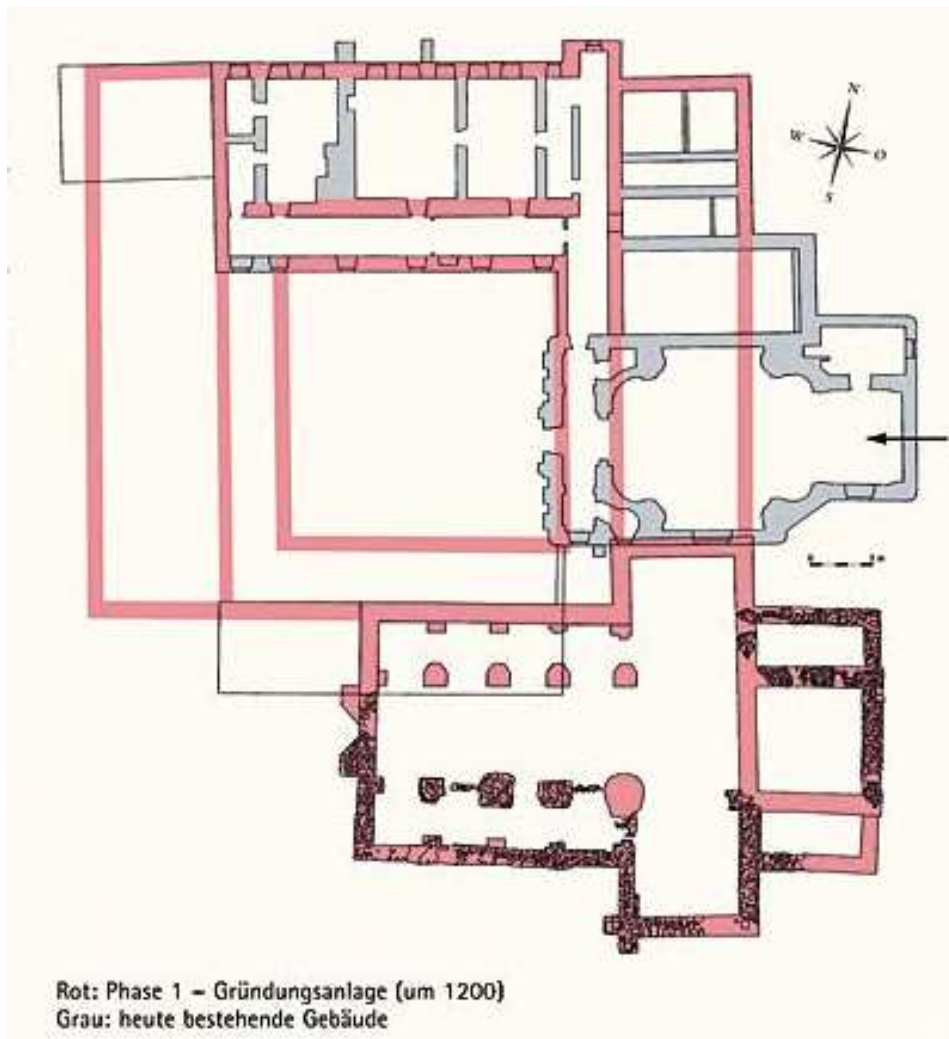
Klostermarienberg, (rekonstruierter) Grundriss
